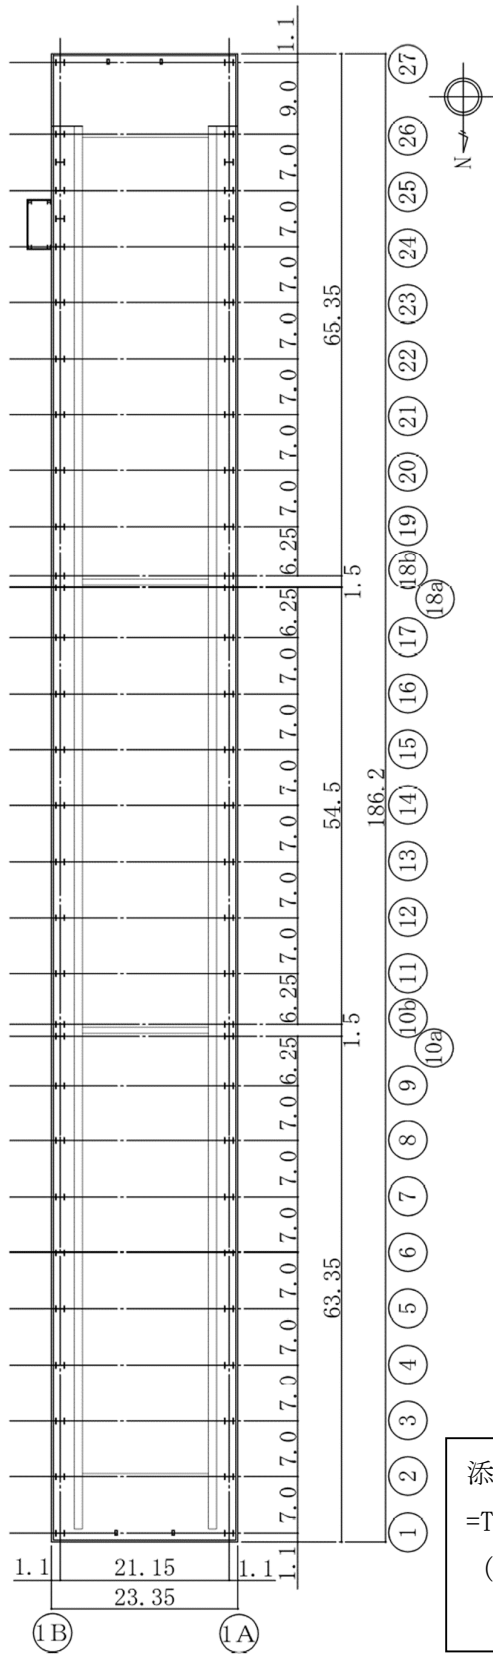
1階平面図 (G.L. +0.635) (単位 : m)
